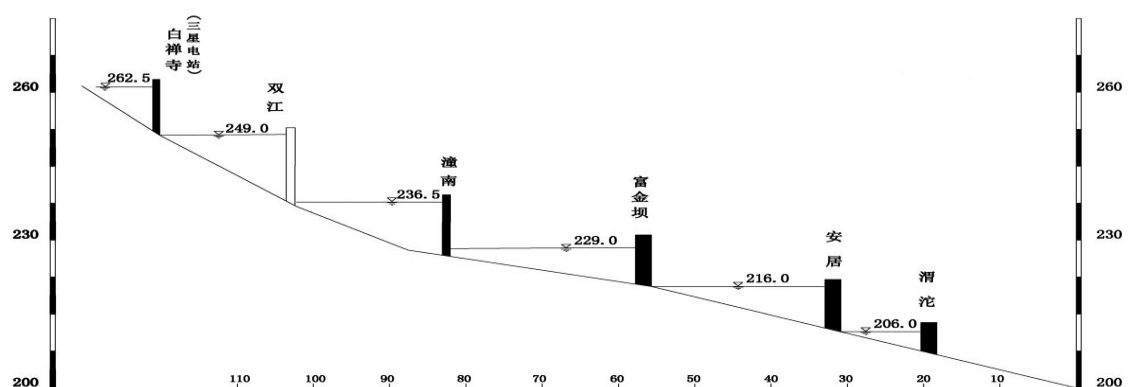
涪江重庆境内枢纽布置纵断面图
